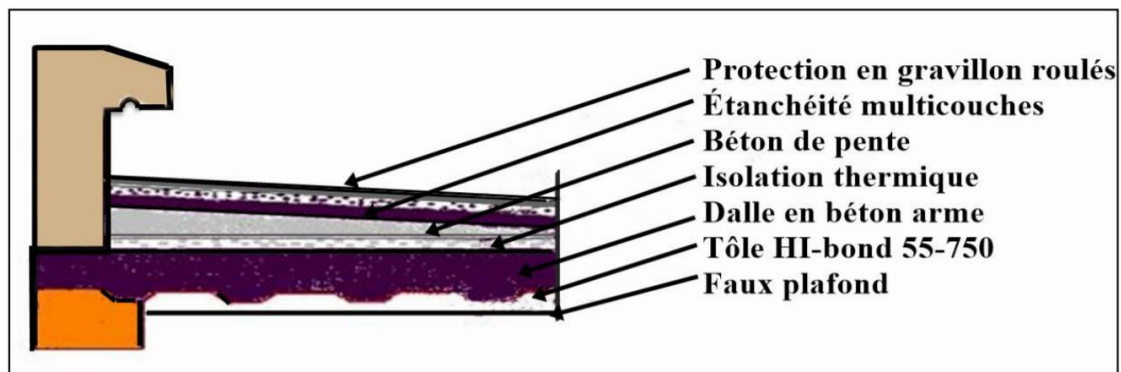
Composition d’un plancher terrasse inaccessible
